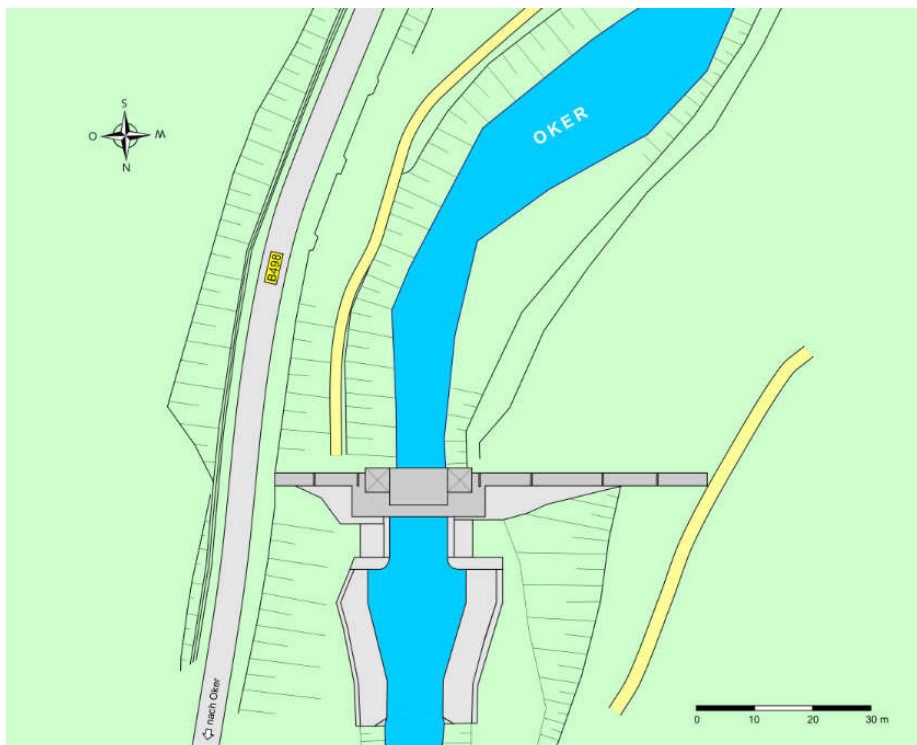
Okertalsperre Unterwasserbecken Lageplan
